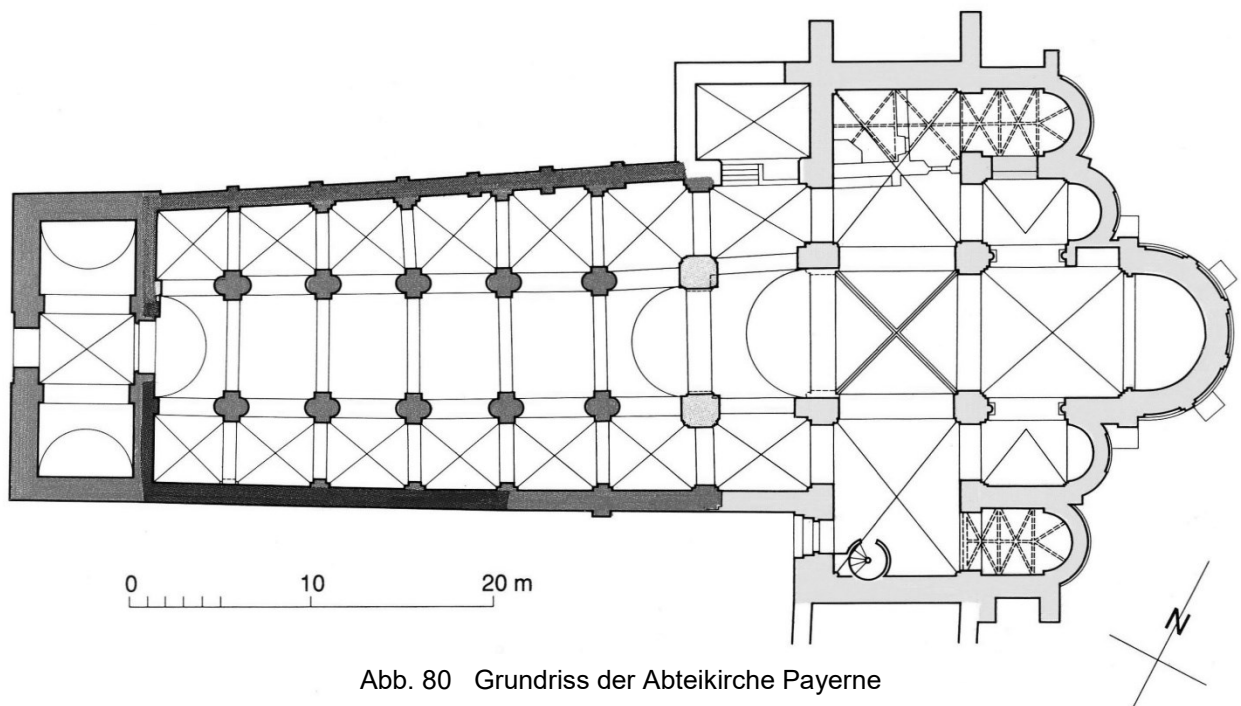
Grundriss der Abteikirche Payerne
